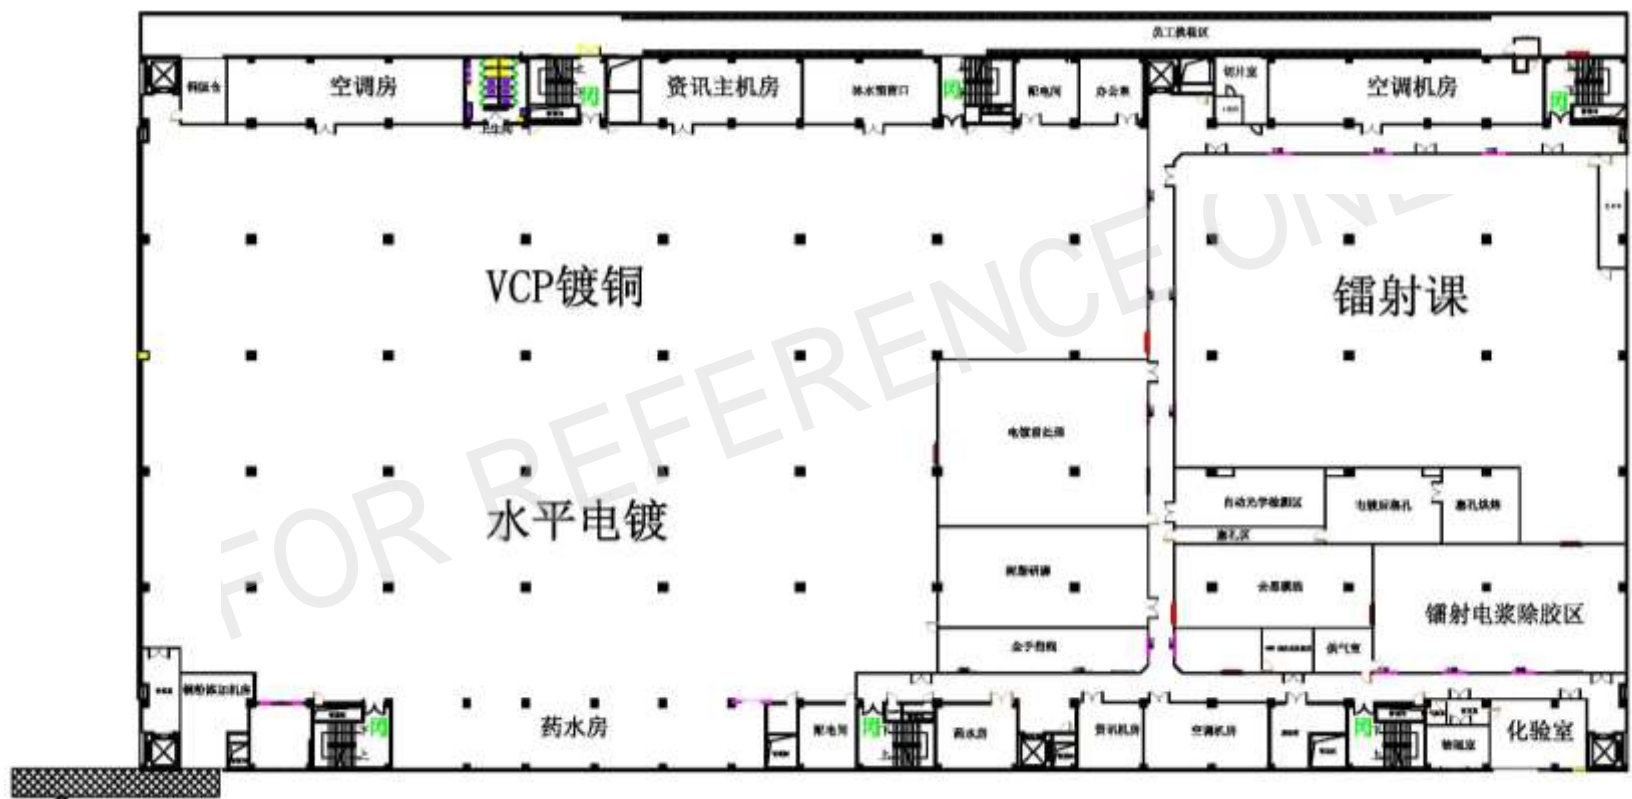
鹏鼎公司 A3 栋厂房二层车间平面布置图
